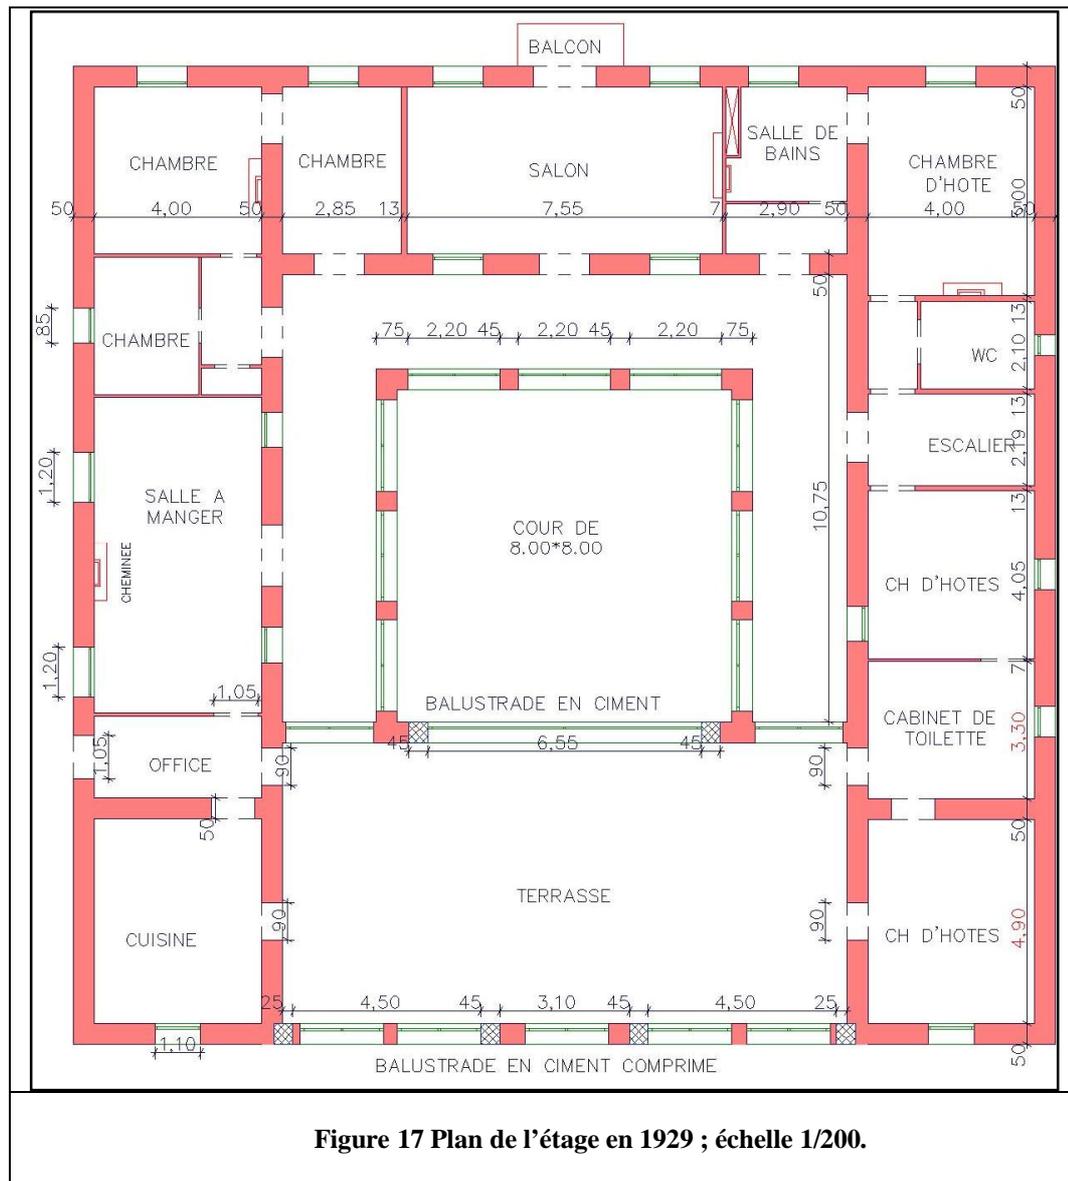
Plan de l'étage en 1929 ; échelle 1/200.
